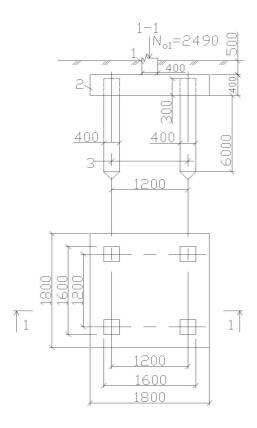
Монтажная схема свайного кустового фундамента: 1- колонна; 2- ростверк; 3- сваи
